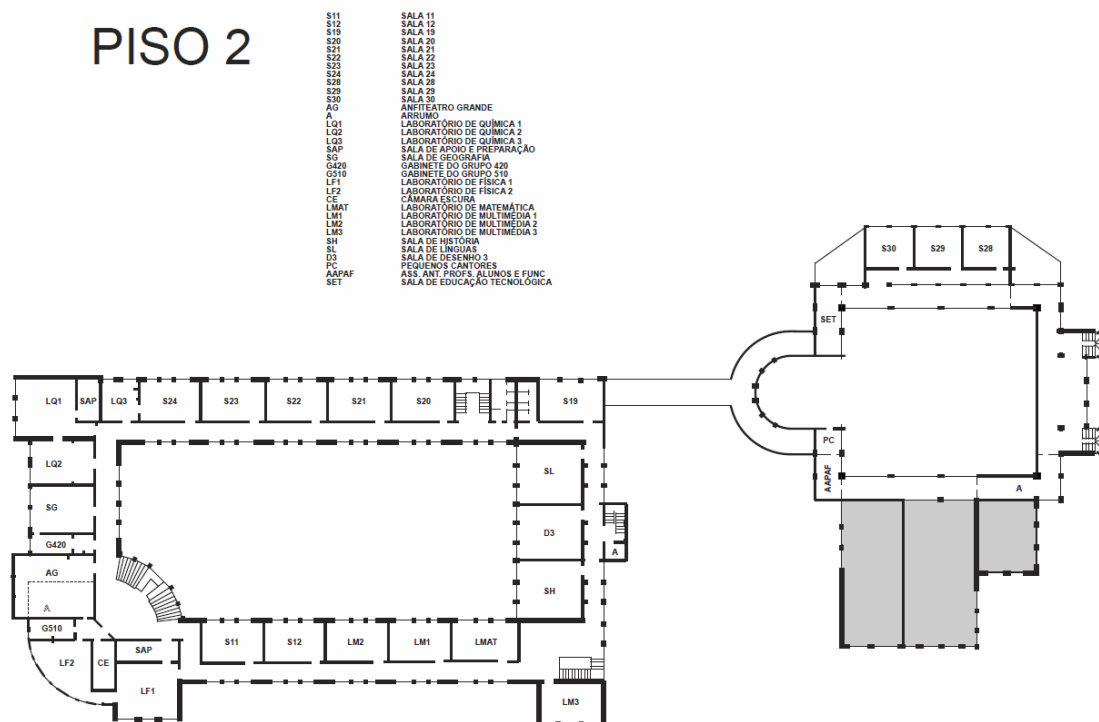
Escola Secundária José Falcão. Planta do 2.º piso. (Fonte: Arquivo ESJF)
